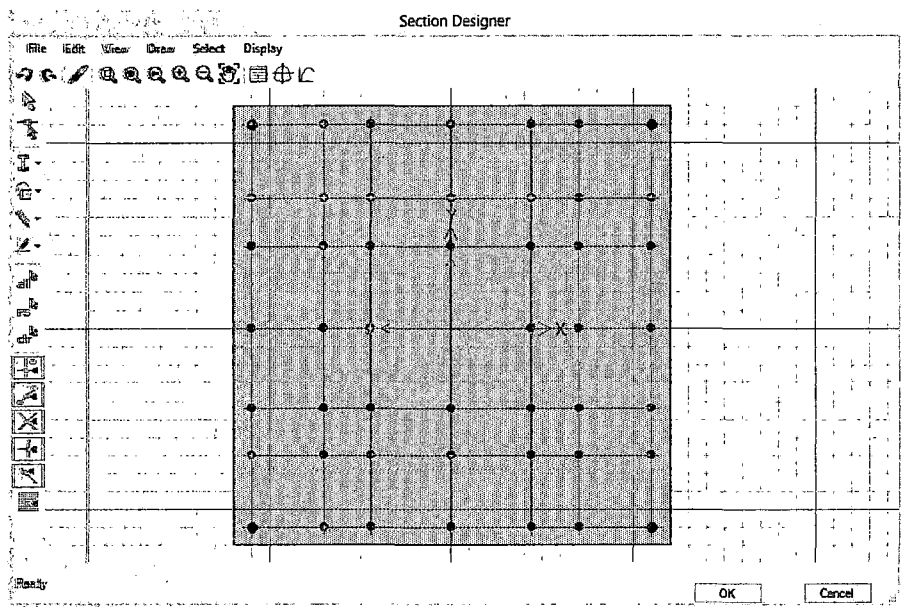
Acero mínimo distribuido en sección de pedestal.
